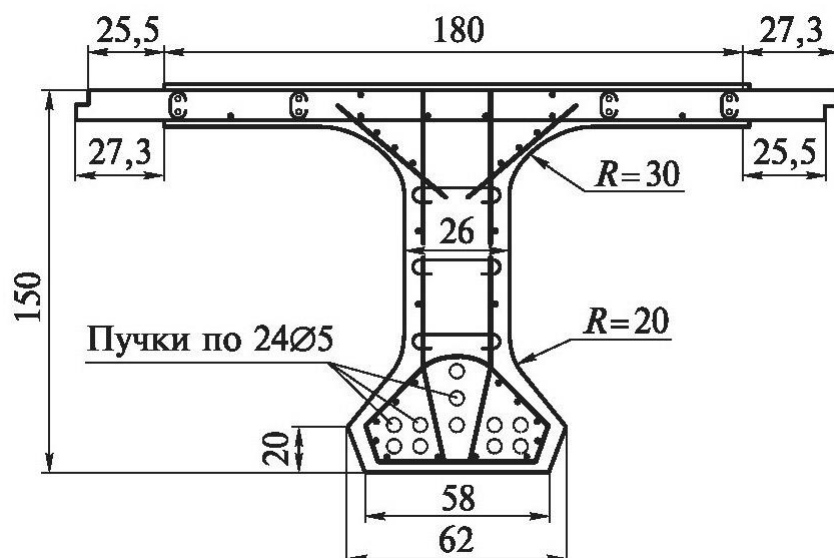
Поперечное сечение ребристых балок в пролете и на опоре и их армирование ненапрягаемой и напрягаемой арматурой
